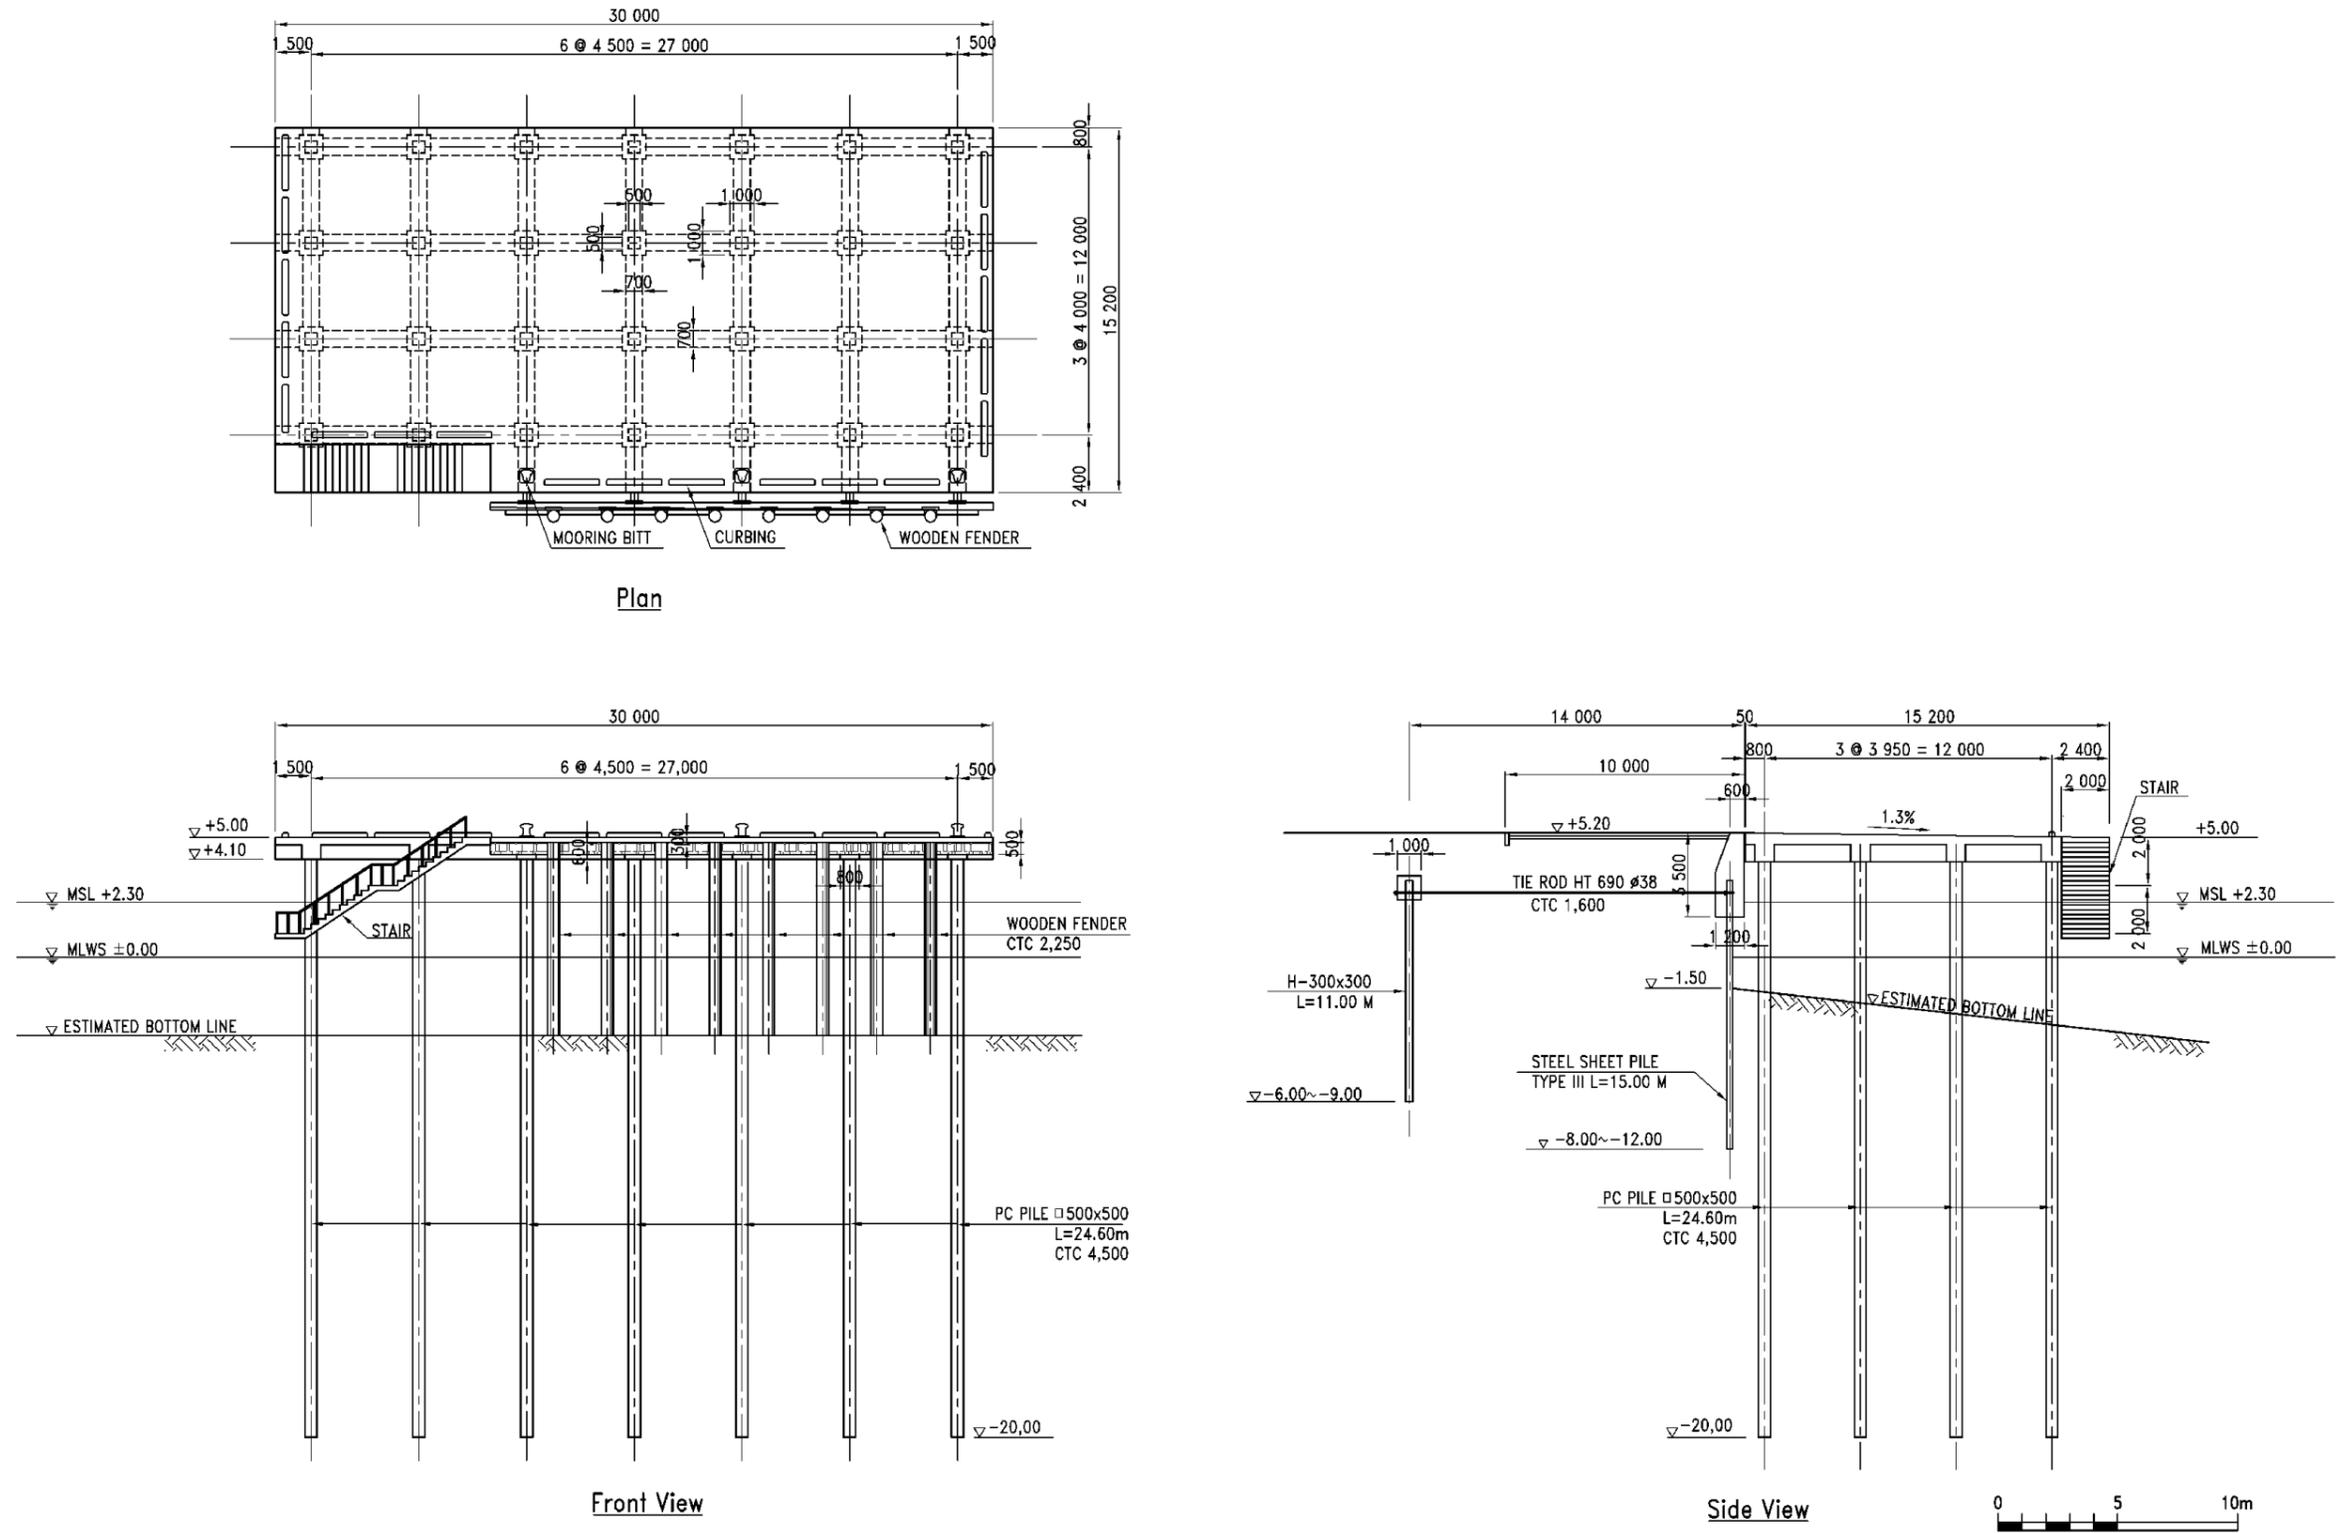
Plan Típico y Sección de Pared de Muelle
